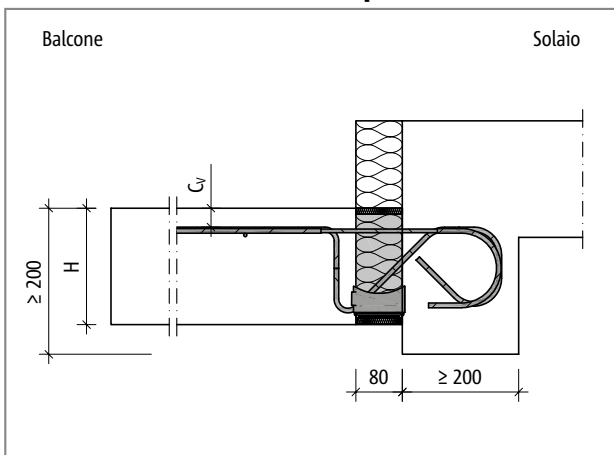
Schöck Isokorb® T tipo KL-O-M1 – KL-O-M7: balcone con abbassamento di quota e isolamento esterno
